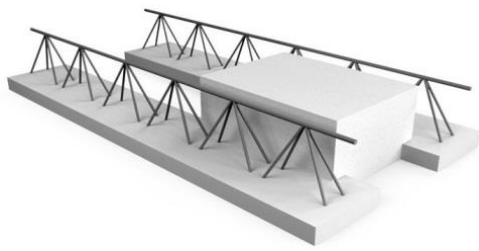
Вид перекриття з Т-подібних блоків газобетону на балки
